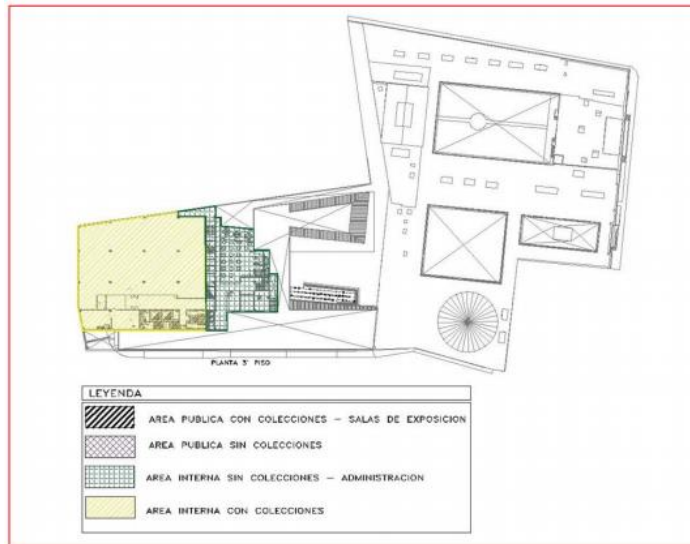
Planta 3er Piso. Fuente: Equipo consultor.
